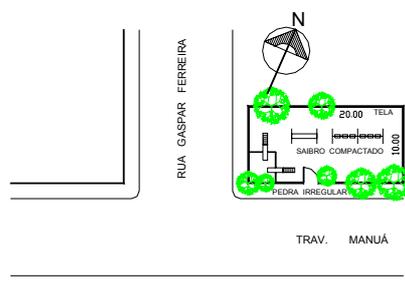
Planta da Área Verde 7 do CHSB com as modificações físicas
